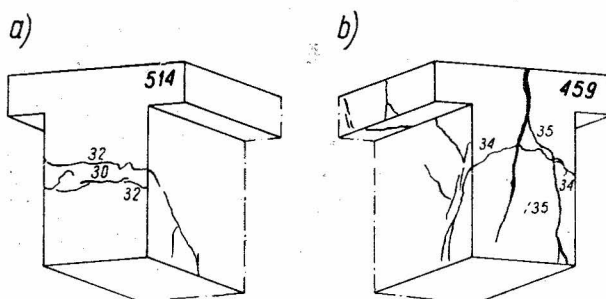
Fissures sur les faces frontales des poutres dans les essais [63] : a) poutres avec des barres munies de crochets pliés à 90°, b) poutres avec des barres munies de crochets circulaires
